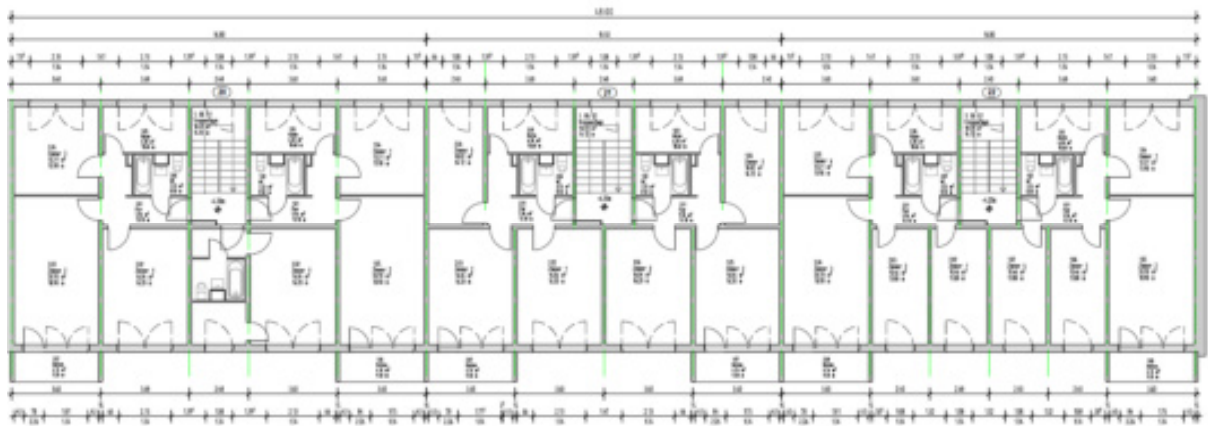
Regelgeschoss Grundriss beispielhafter Block Lessingstr 20-22 (Quelle: IBNuP)
